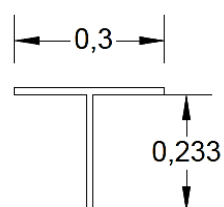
Sección transversal clase 4 viga de piso a compresión. Elaboración propia con AutoCAD
